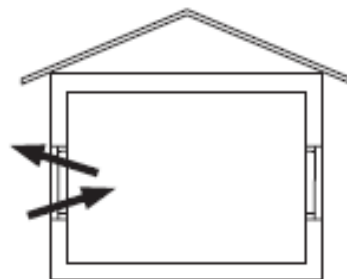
Sistema de ventilação em fachada única. ^[38]
